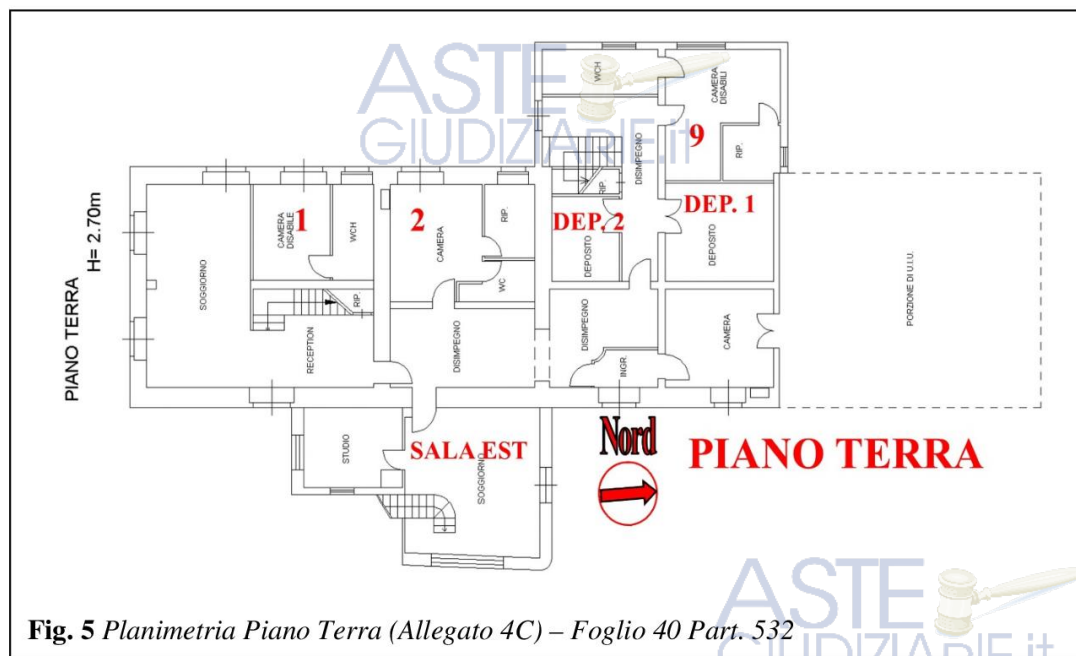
Planimetria Piano Terra (Allegato 4C) – Foglio 40 Part. 532
